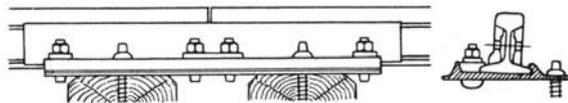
Stoßbrücke. (Aus Bräuning, Grundlagen.)
